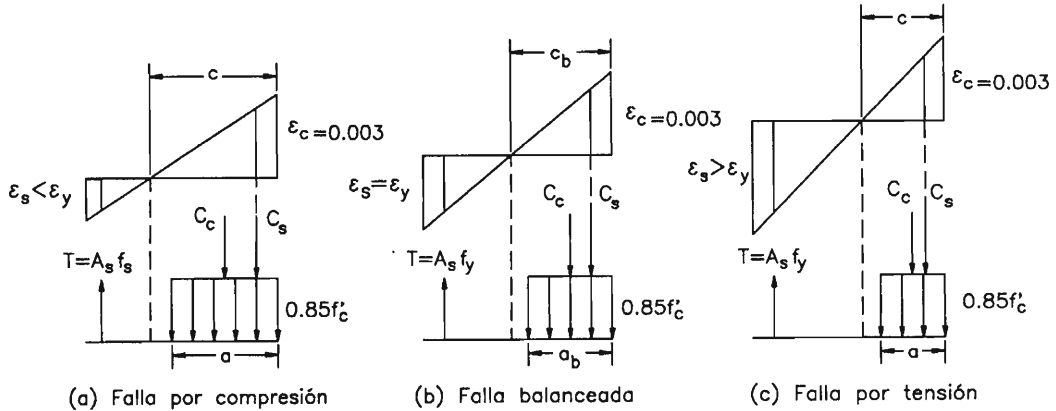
Tipos de fallas de columnas sometidas a flexo-compresión
